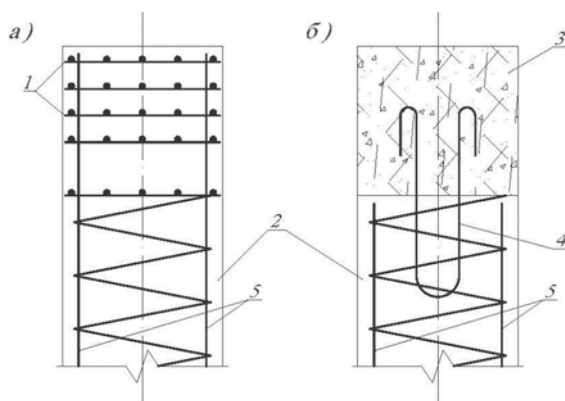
Голова сваи: а – армирование головы типовой железобетонной сваи; б – армирование ударостойкой сваи с головой из сталефибробетона; 1 – поперечные сетки; 2 – ствол сваи; 3 – голова сваи из сталефибробетона; 4 – соединительная петля; 5 – основная арматура сваи
